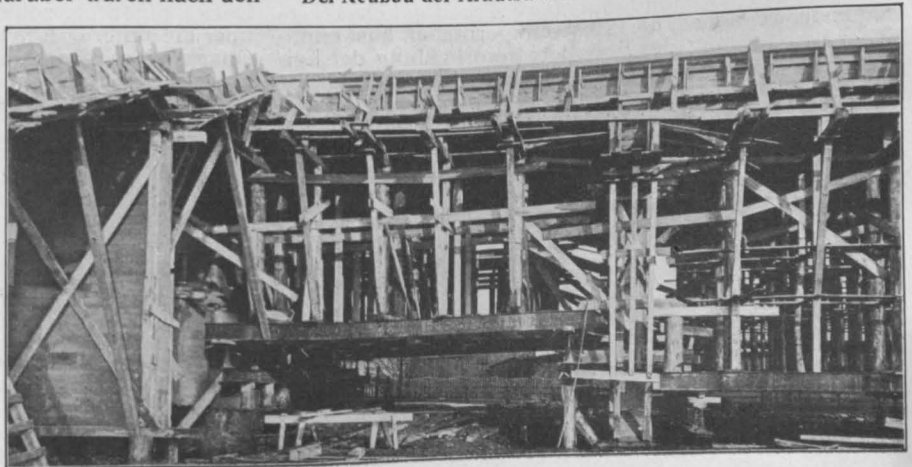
und 9. Ausführung der Brücke. Gerüste und Schalung. Der Neubau der Arndtstraßen-Ueberführung in Königsberg i. Pr.
